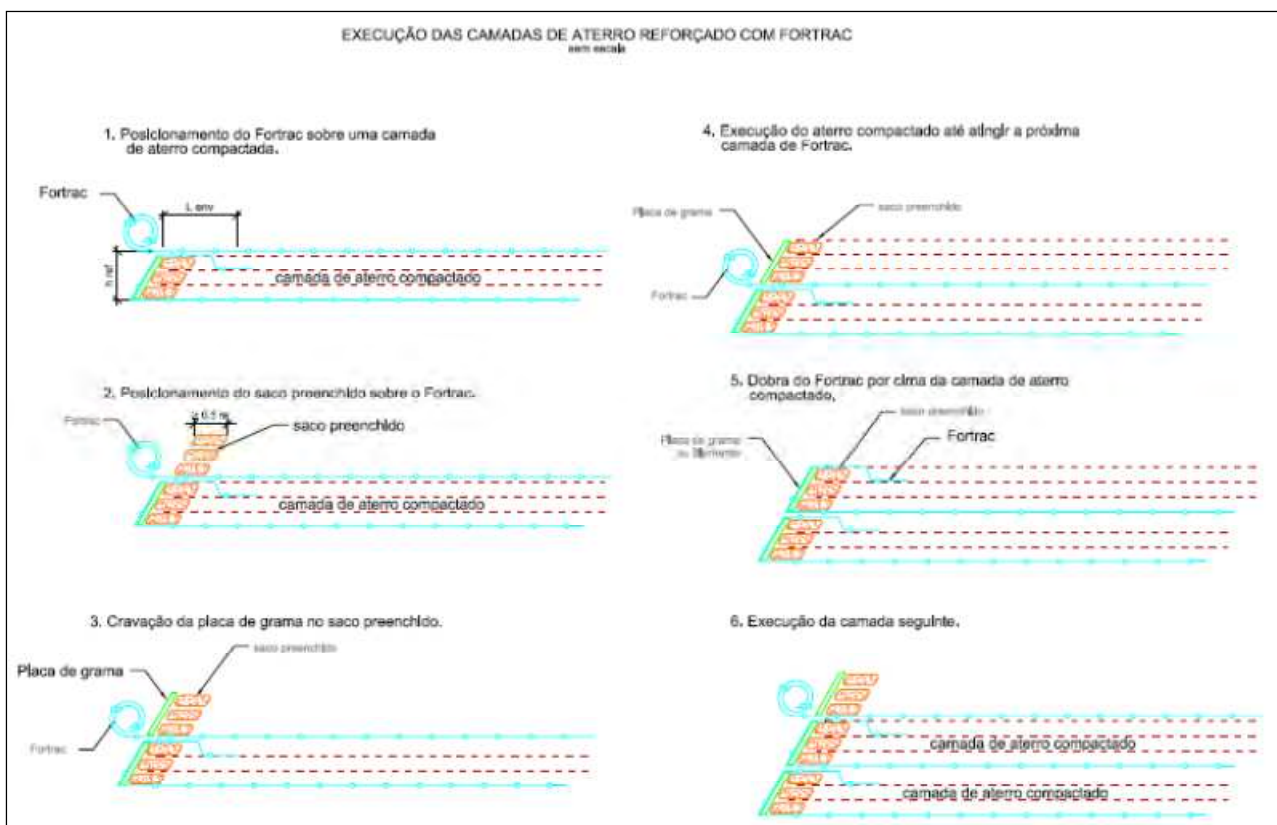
Procedimento construtivo de muro com sistema autoenvolvido e faceamento vegetal (Silva ET al., 2008).
